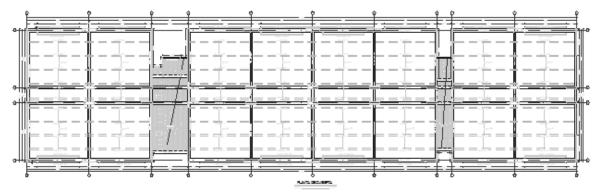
Planta de cubierta de la torre 1 urbanización San Francisco
